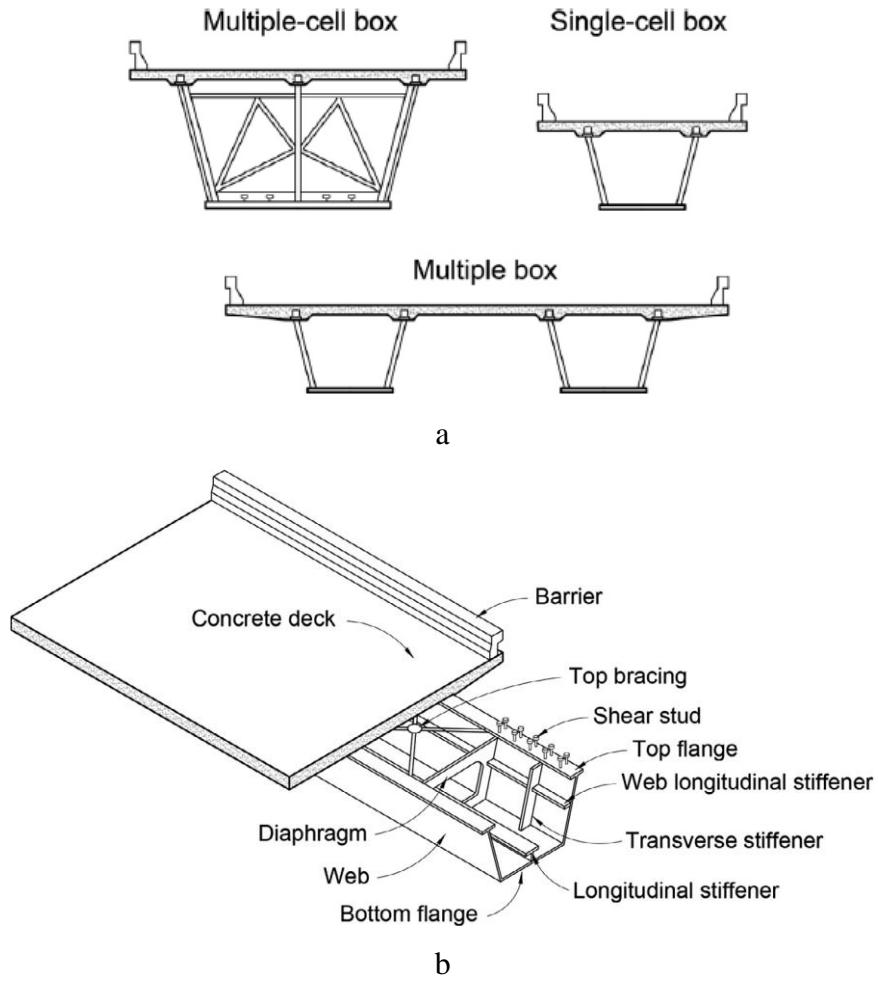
Puentes tipo cajón: a) viga armada, b) configuración de armado del puente. [27].
